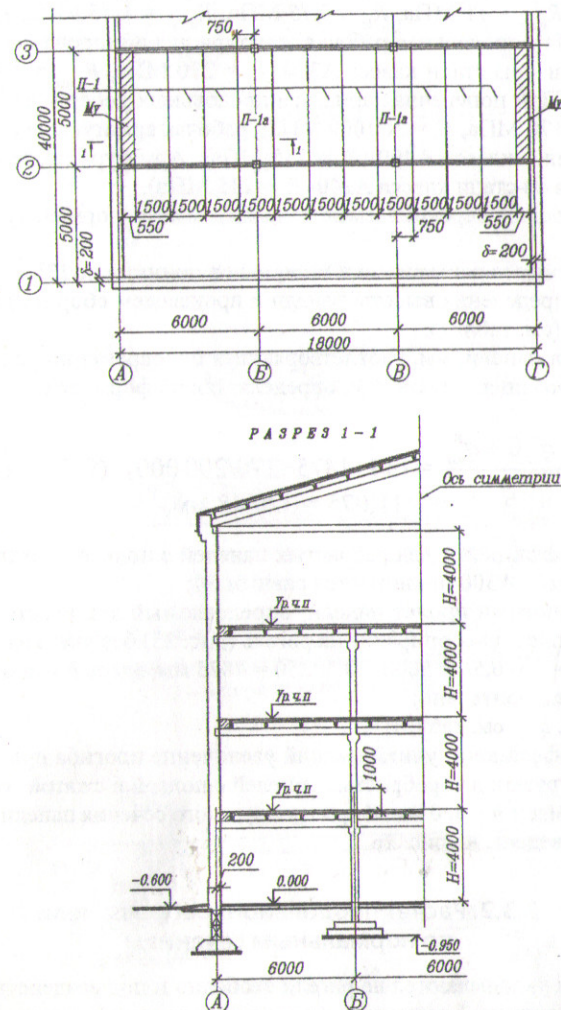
Монтажный план перекрытия и вертикальный разрез здания I-I
